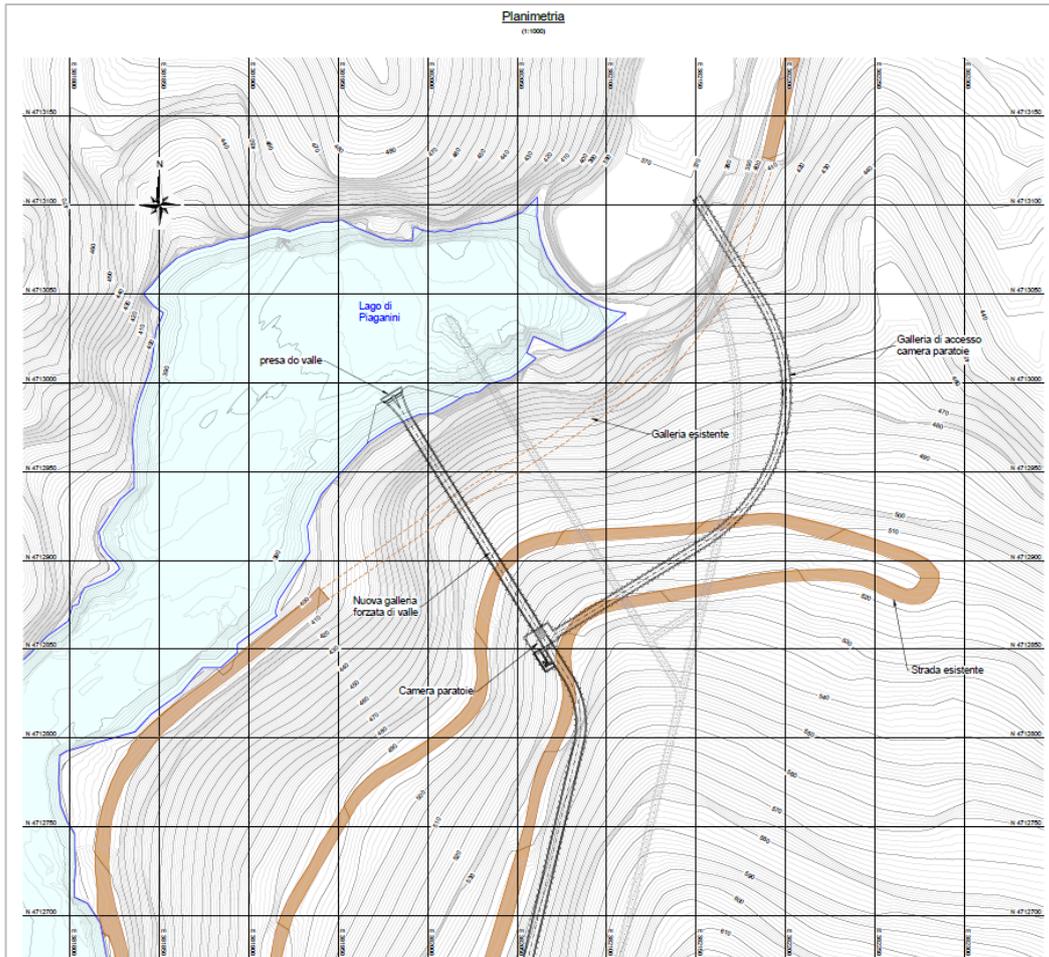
Nuova galleria forzata di scarico/aspirazione sulla derivazione Piaganini – zona della nuova presa – pianta
